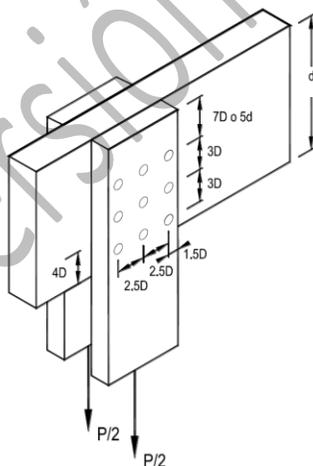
Espaciamiento entre pernos de uniones con cargas perpendiculares a la fibra
